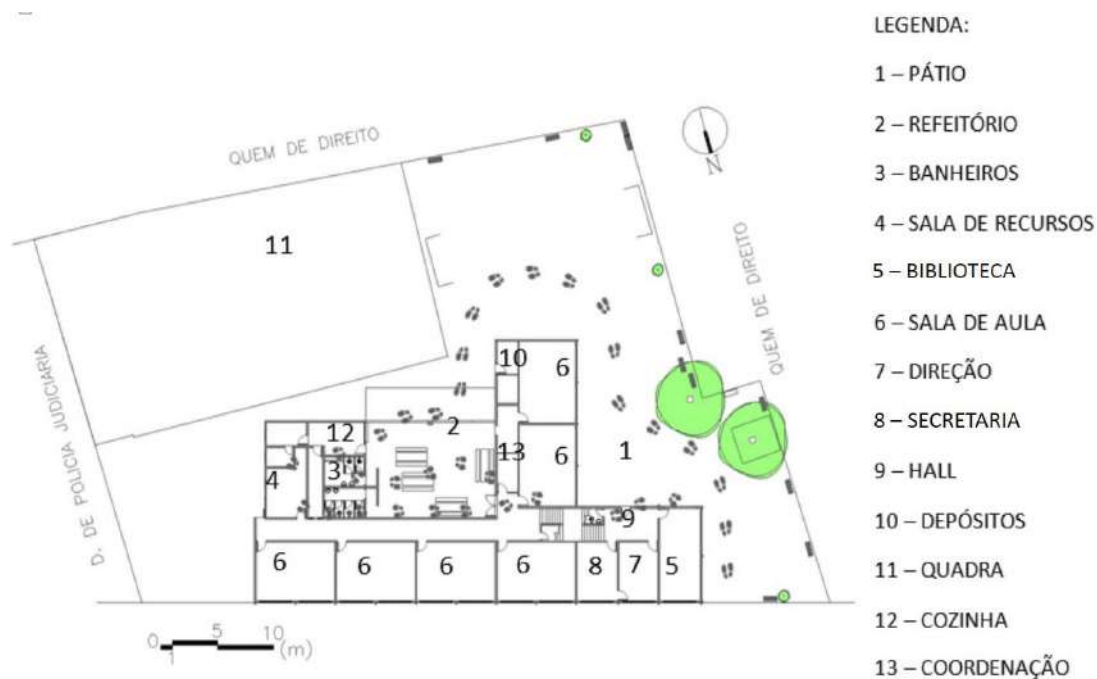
Percurso do Walkthrough no primeiro pavimento -
